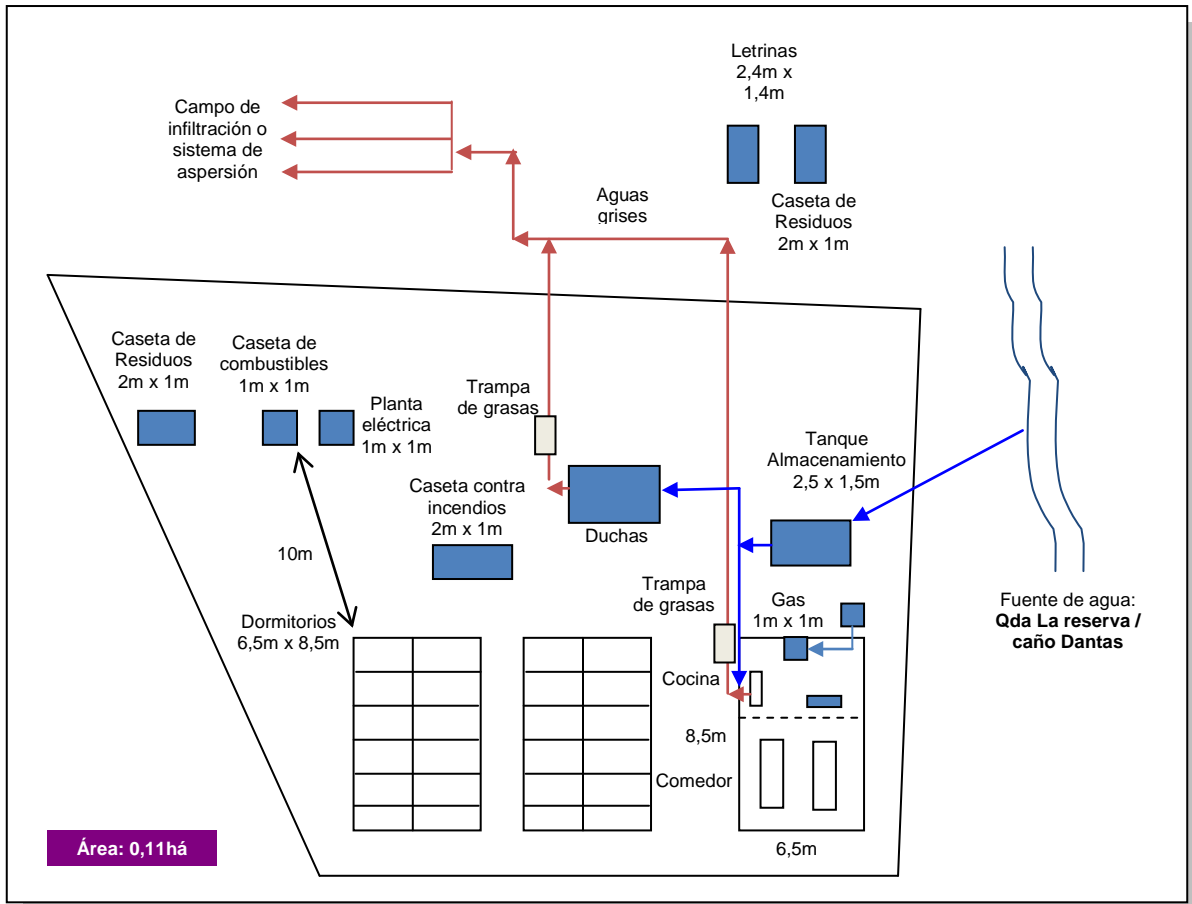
Campamento volante tipo de un levantamiento sísmico
